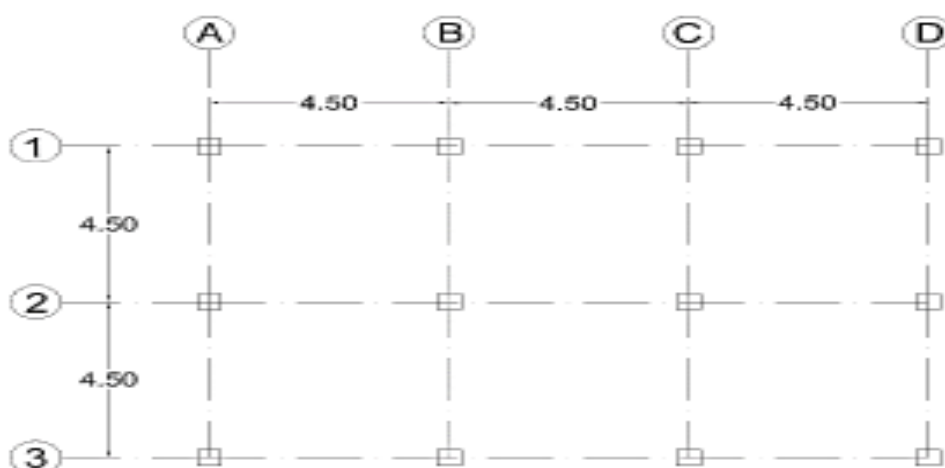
Vista en planta de la edificación (Cabrera & Sánchez, 2016)
